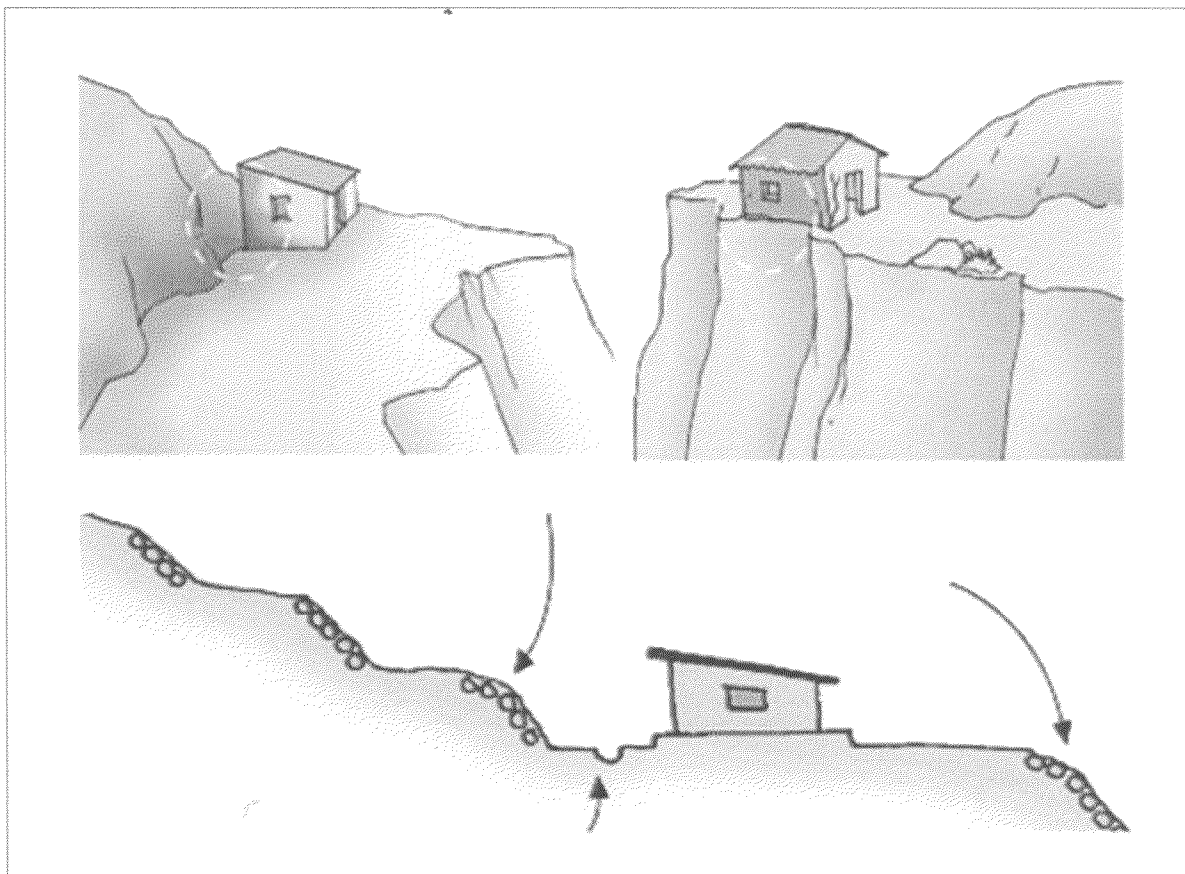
Extracto del manual de construcción: Ejemplo de la inadecuada ubicación de las viviendas afectadas por el sismo (arriba) y obras adicionales de protección, señalando muros de contención y drenaje pluvial (abajo)
